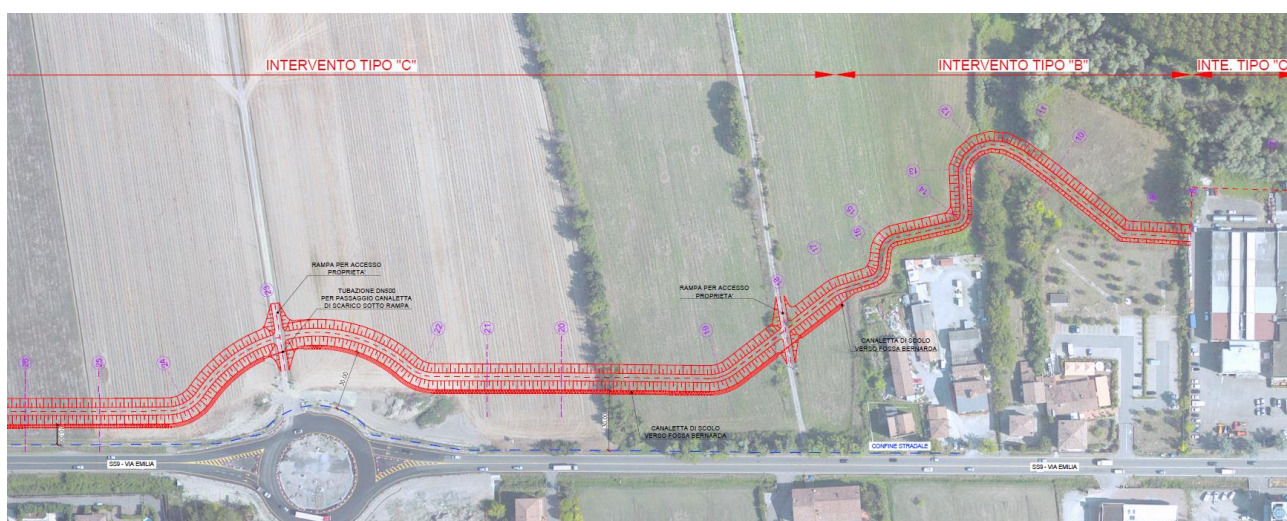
Stralcio planimetria di progetto (1 di 4).
